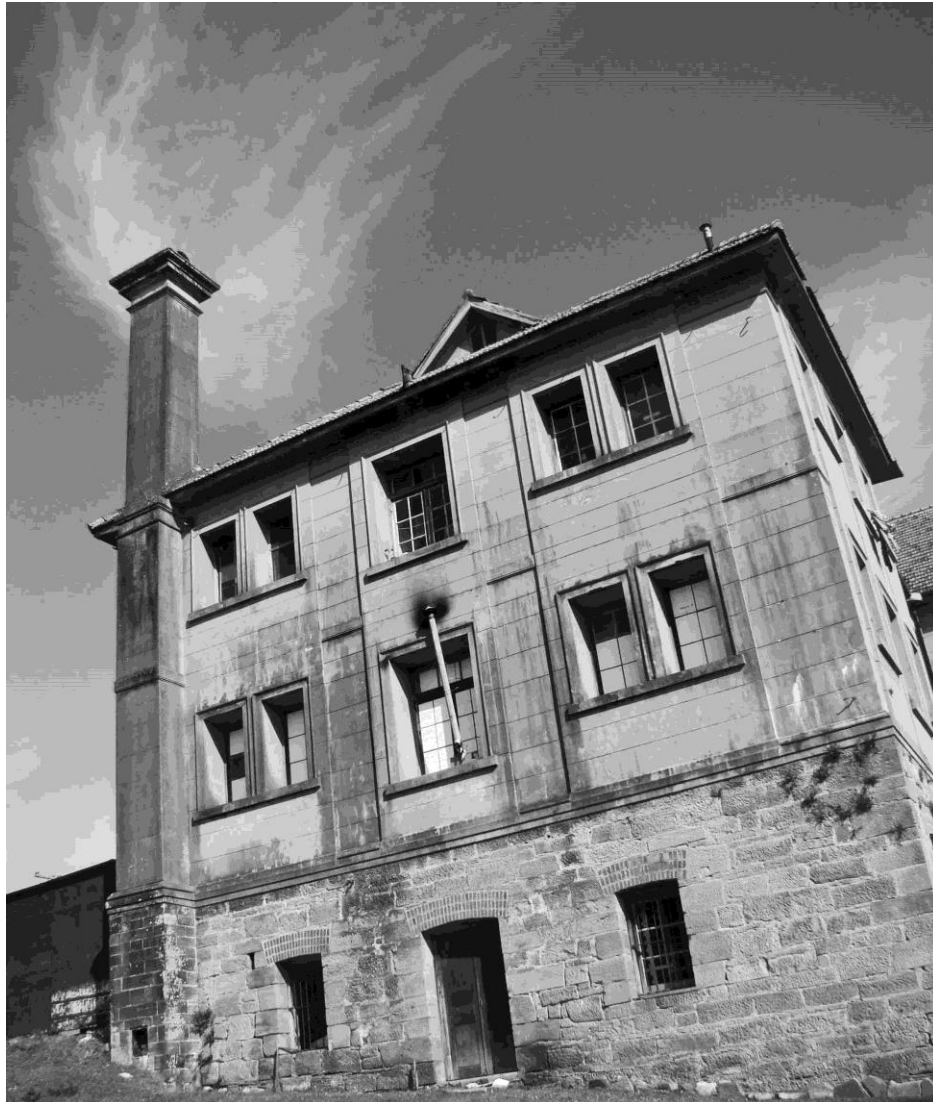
Fachada leste. Fonte: Acervo do Autor, 04 jul 2017.
